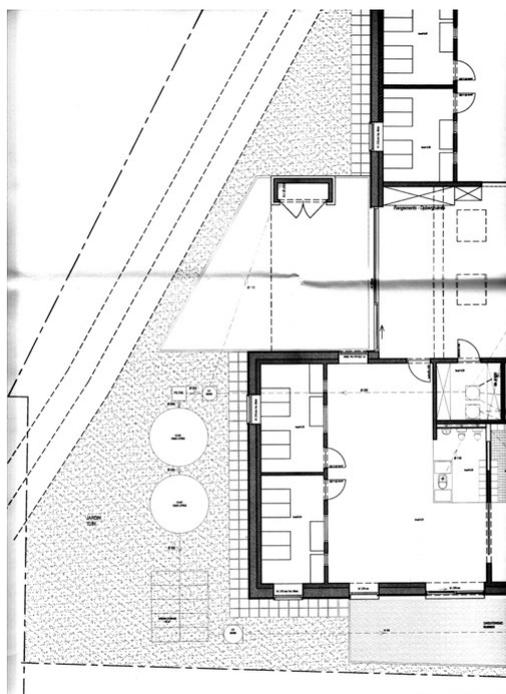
plan d'implantation (extrait du dossier – plan A3/01) Fig.2 : plan rez-de-chaussée (extrait dossier plan égouttage PU04)
